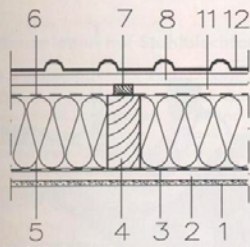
Geneigtes Dach mit diffusionsoffener Unterspannbahn ($s_d \leq 0,2 \text{ m}$) und Dampfsperre
